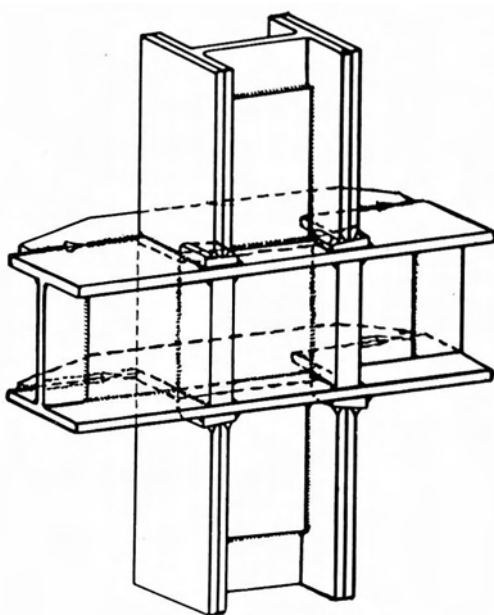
Knotenausbildung Gerlinger Hochhaus, Köln (Archiv: Beratungsstelle für Stahlverwendung, Düsseldorf)
